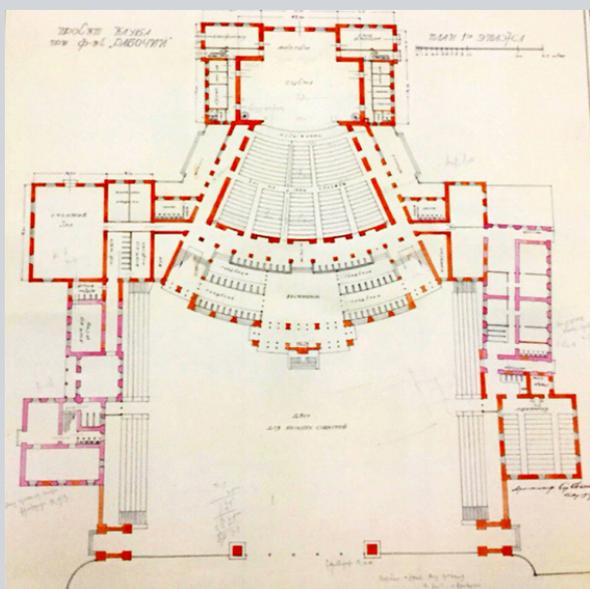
Проектный план первого этажа (ЦГАНТД СПб)
